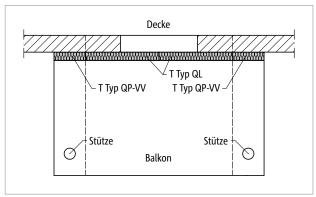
Schöck Isokorb® T Typ QP-VV und Typ QL: Balkon mit Stützenlagerung, Anschluss bei unterschiedlichen Auflagersteifigkeiten
